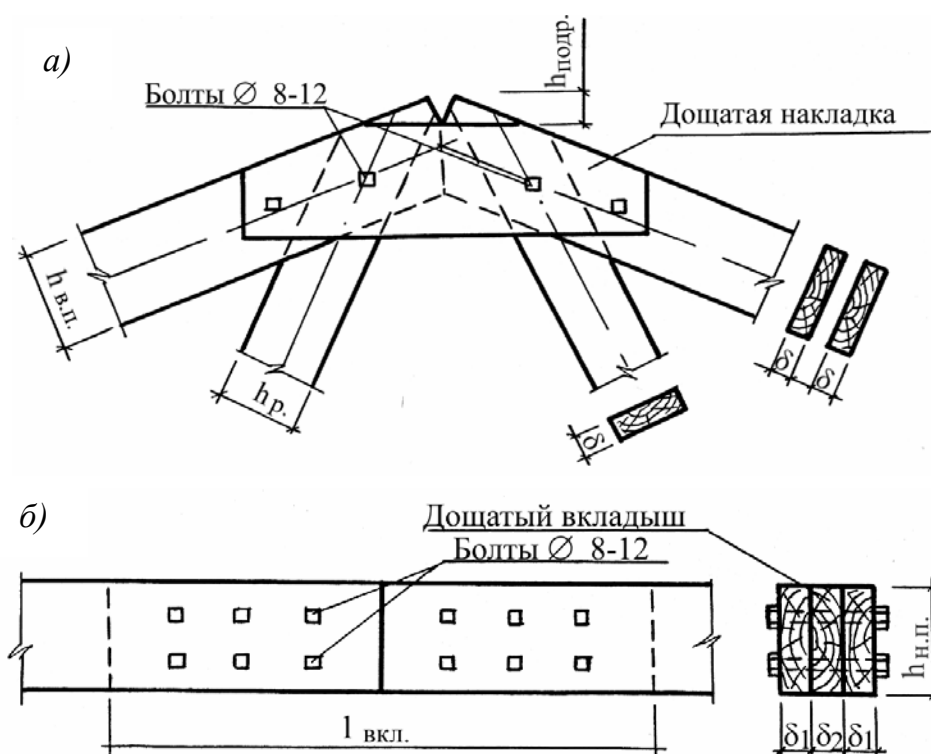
Монтажные узлы бесфасоночных ферм: а – по коньковому узлу (по верхнему поясу); б – по нижнему поясу
